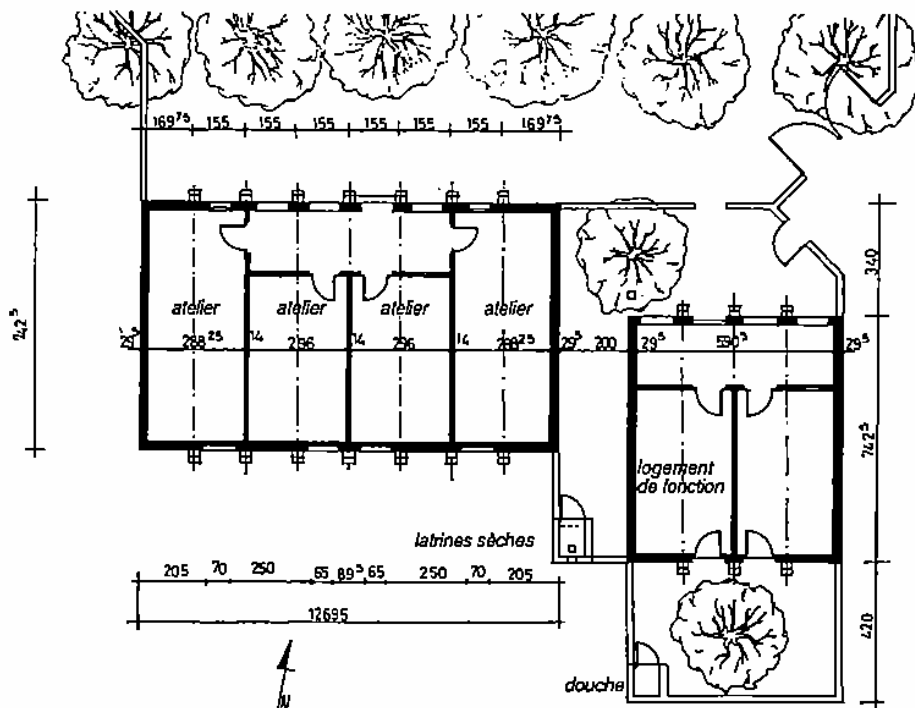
Plan de la première tranche de travaux : logement de fonction et premier ensemble d'ateliers.
